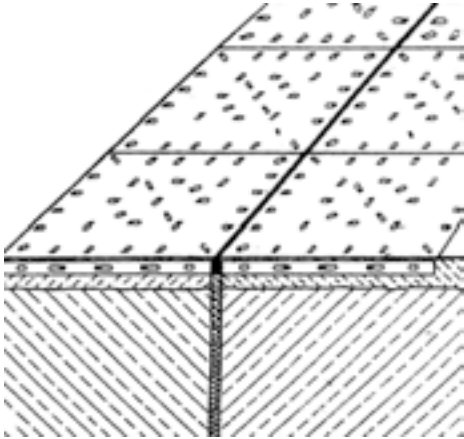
Prinzipielle Konstruktion einer Bewegungsfuge. Verankerung der Profile im Estrich und auf der Betonoberfläche. Für leichte Beanspruchung
